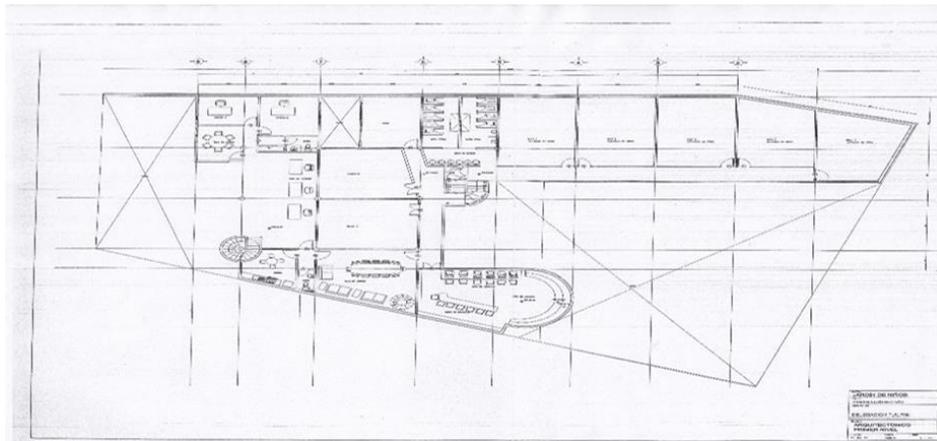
Plano arquitectónico de "Kindergym Coapa" planta baja
